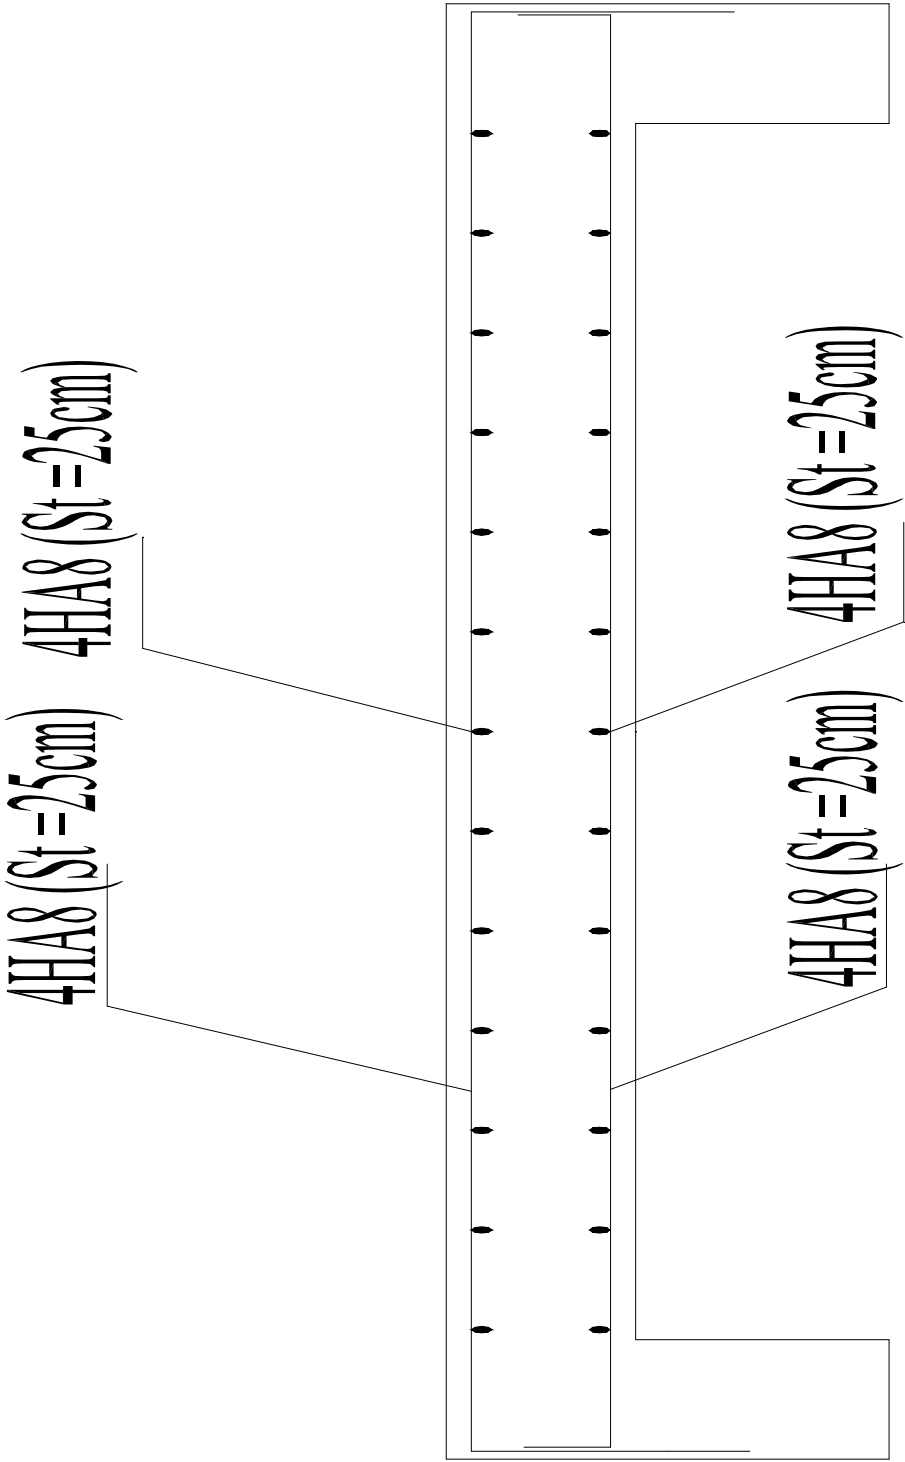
FERRAILLAGE DU PLANCHER EN DALE PLEINE.
